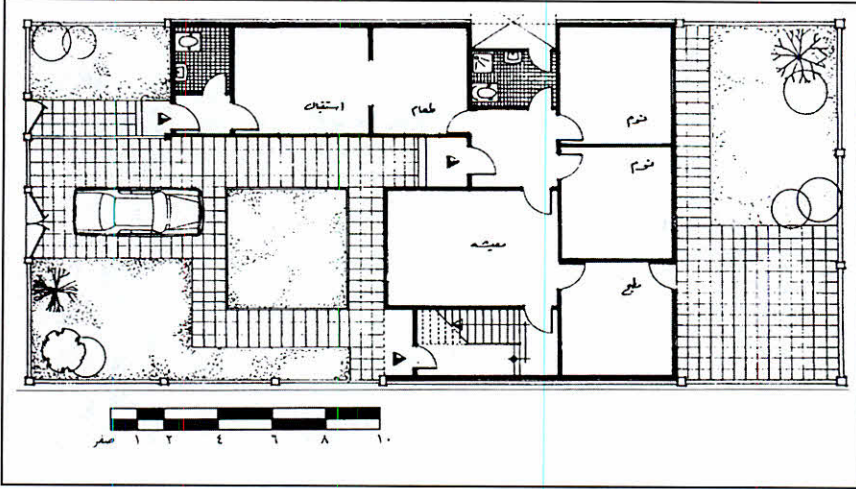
المسقط الأفقي لنموذج وحدات الإسكان العام (فيلا).
